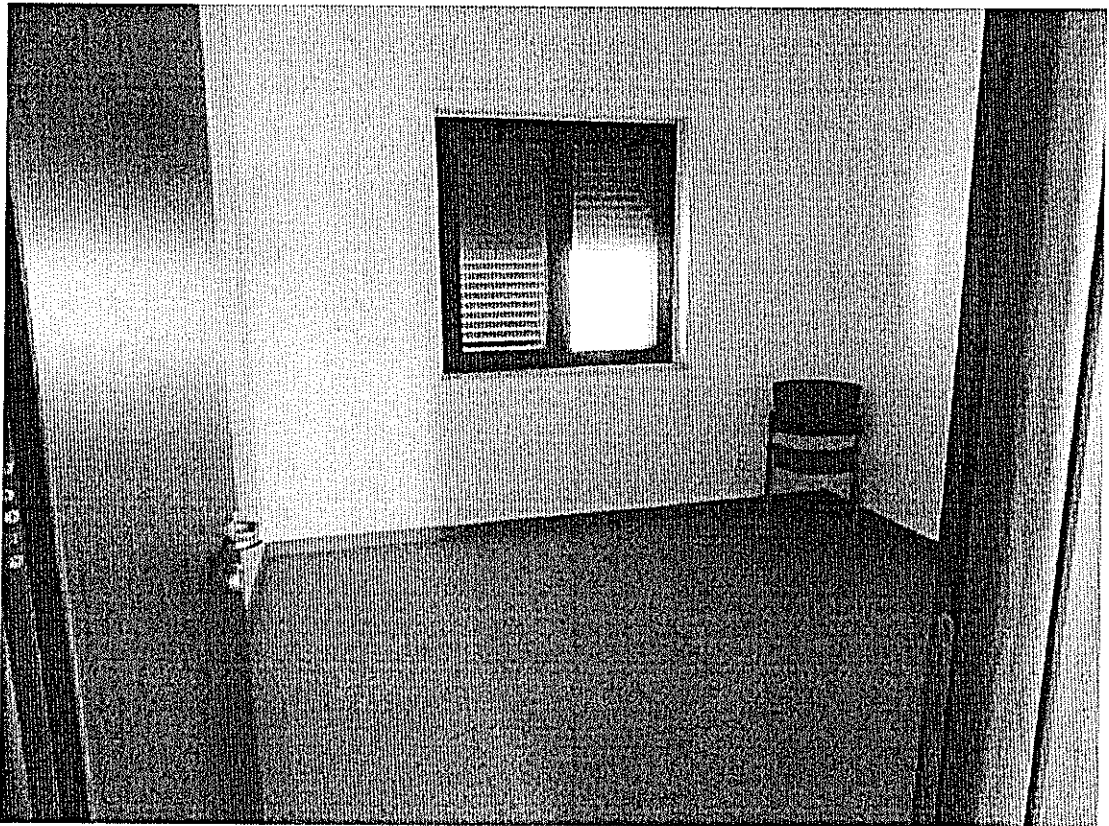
Locale del personale dell'ala destra del primo corpo di fabbrica – piano primo.
